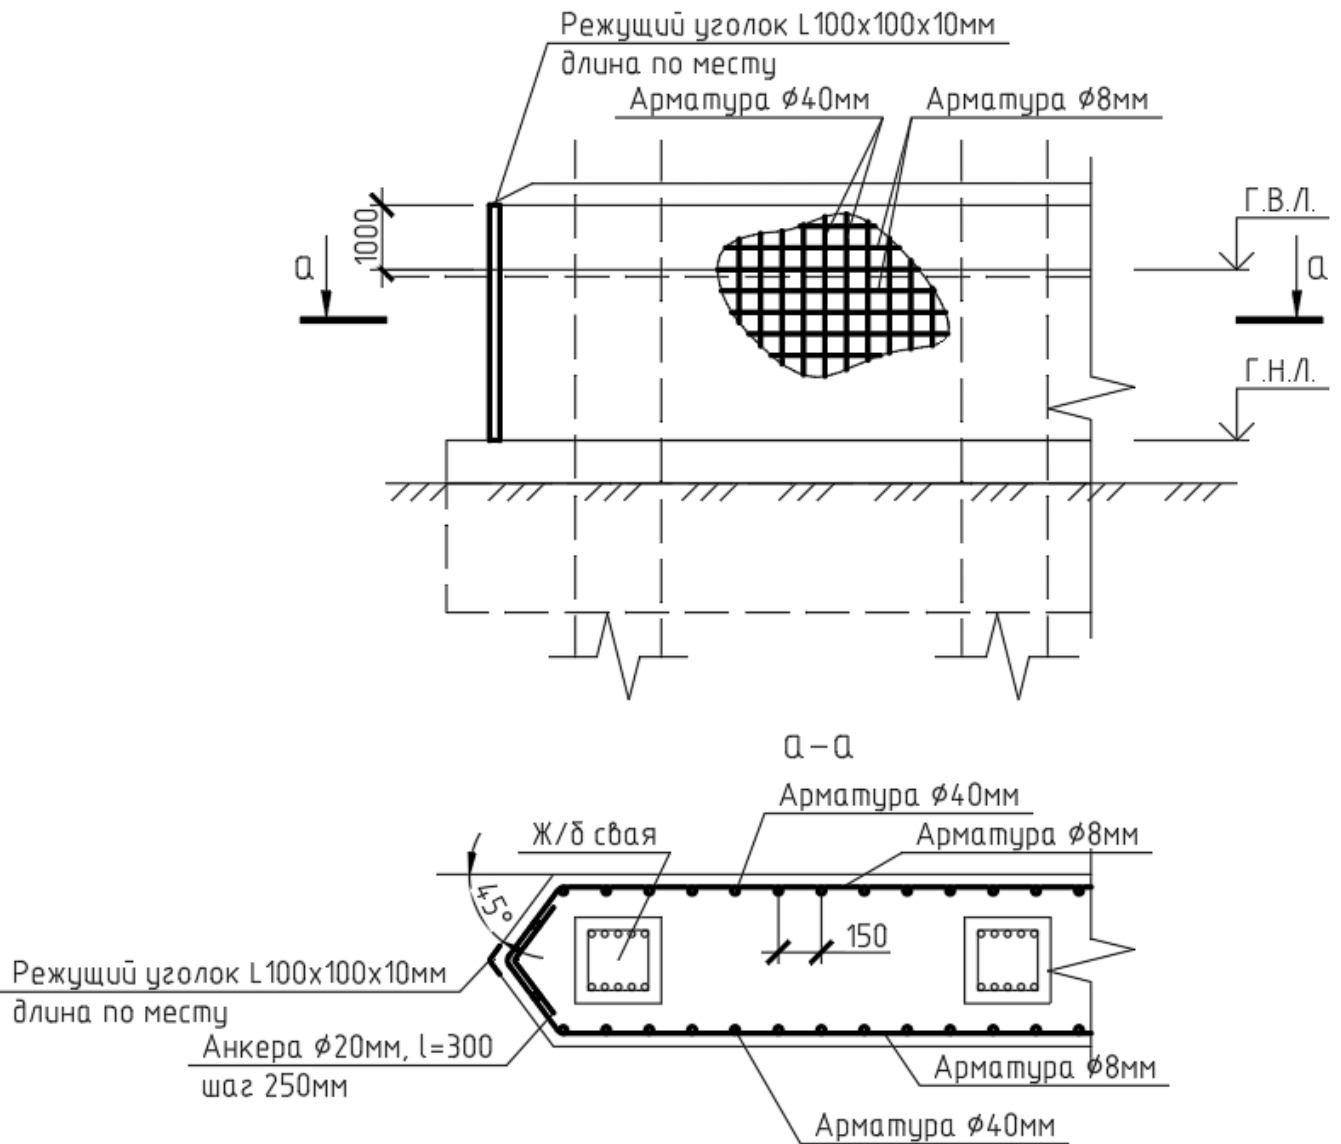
Устройство железобетонной рубашки вокруг свай
